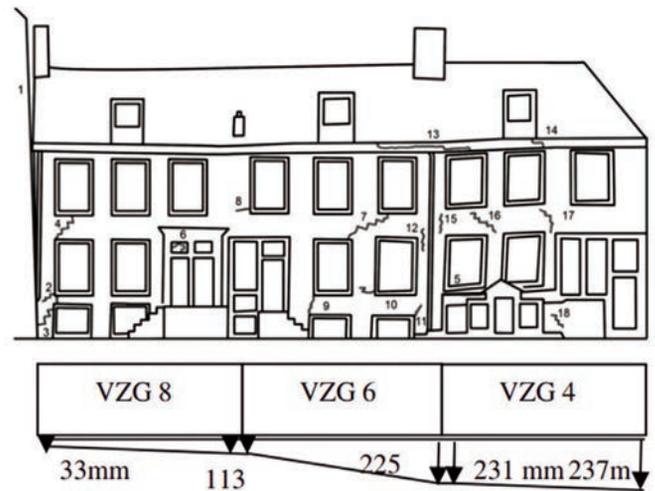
Повреждения и закрепление фасада зданий при строительстве метро:
